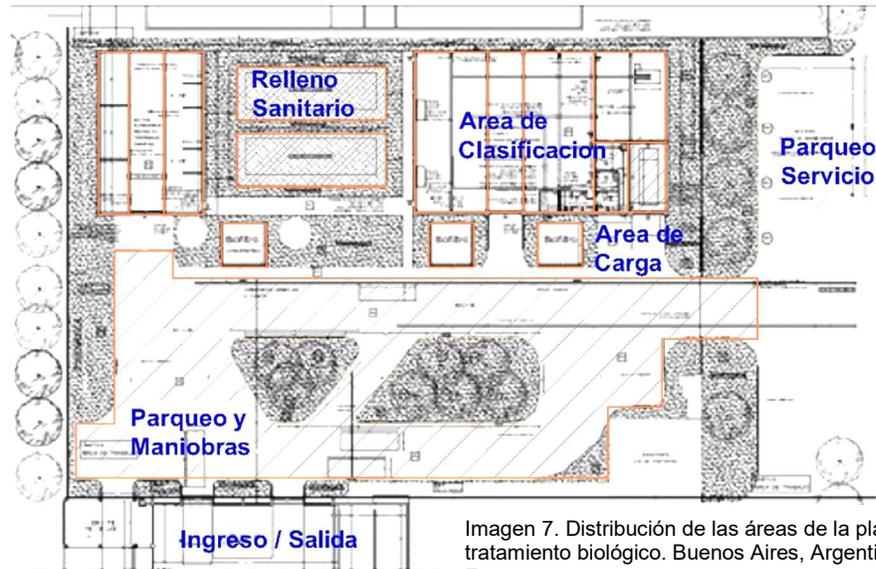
Distribución de las áreas de la planta de tratamiento biológico. Buenos Aires, Argentina. Fuente: ceamse.gov.ar
